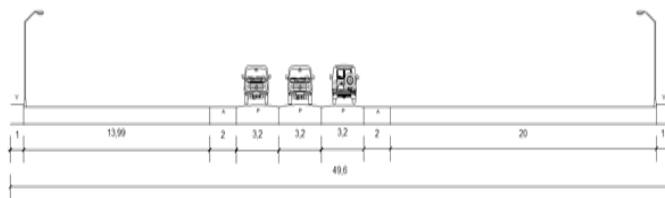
IMAGEN SECCION VIAL CARRETERA PANAMERICANA
